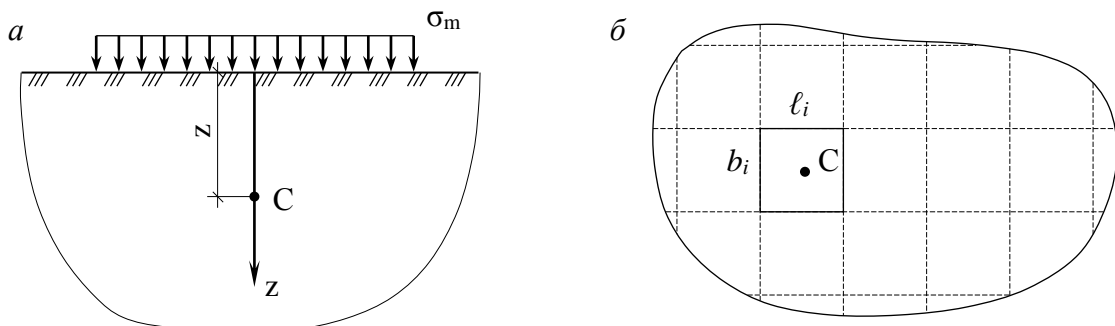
Розрахункова схема для визначення напружень від дії рівномірно розподіленого навантаження: a – переріз; b – план
